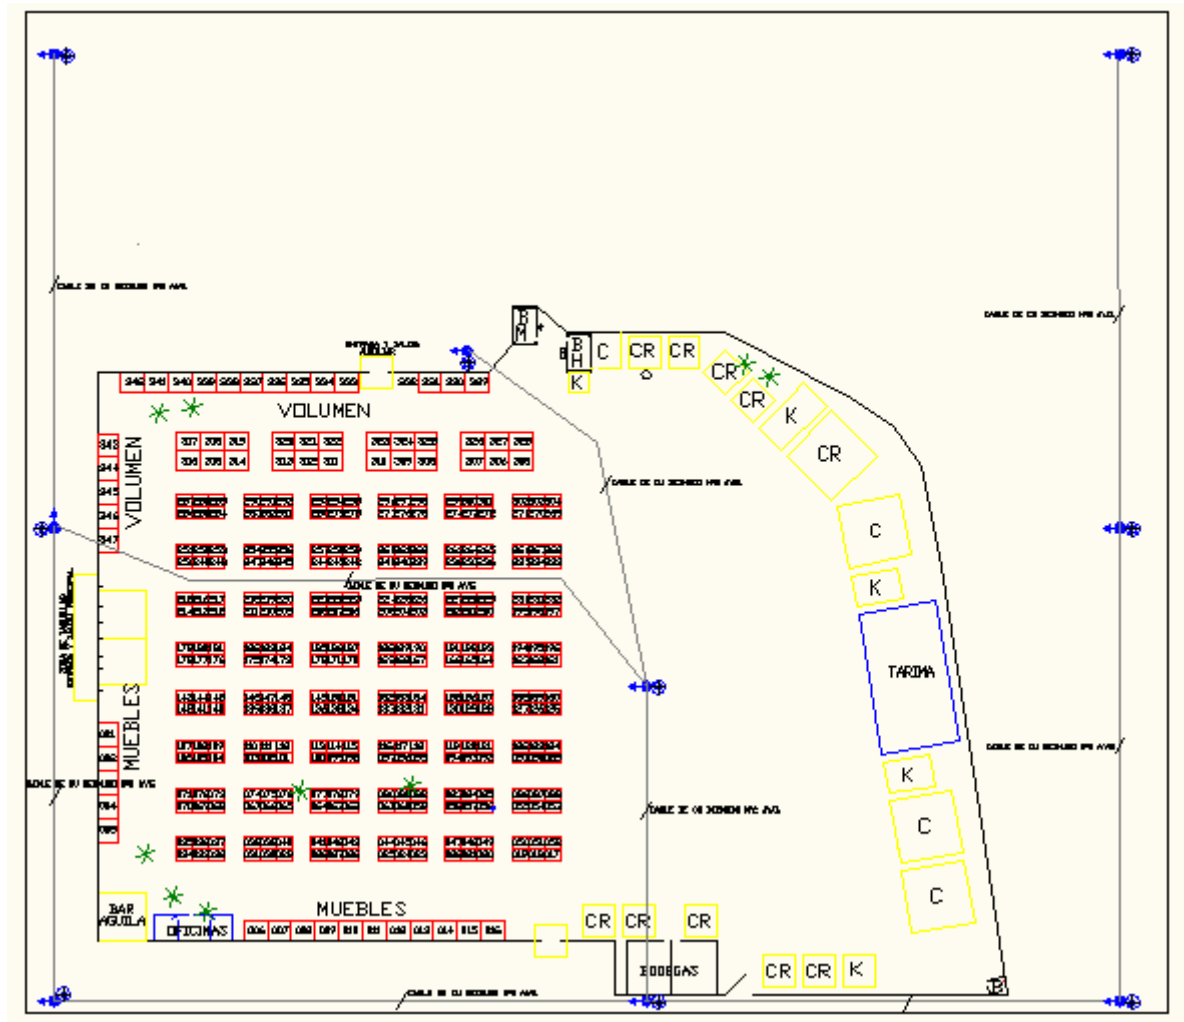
Planimetría y Distribución puntas captadoras en postes.
